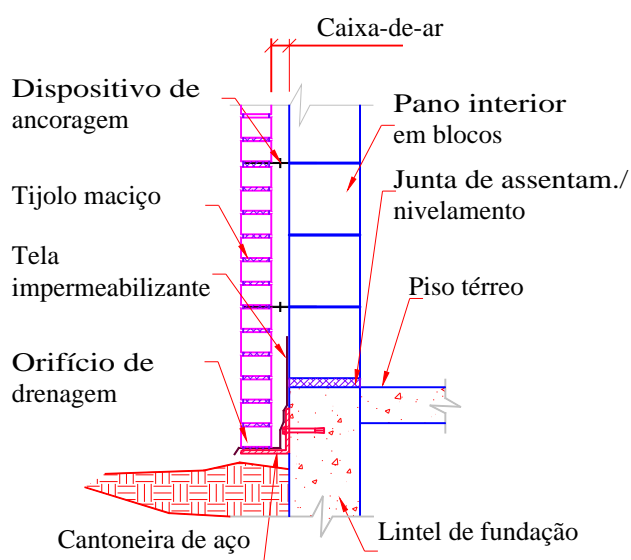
Ligação de parede dupla exterior a lintel de fundação (fonte: CURRAN, 2003)
